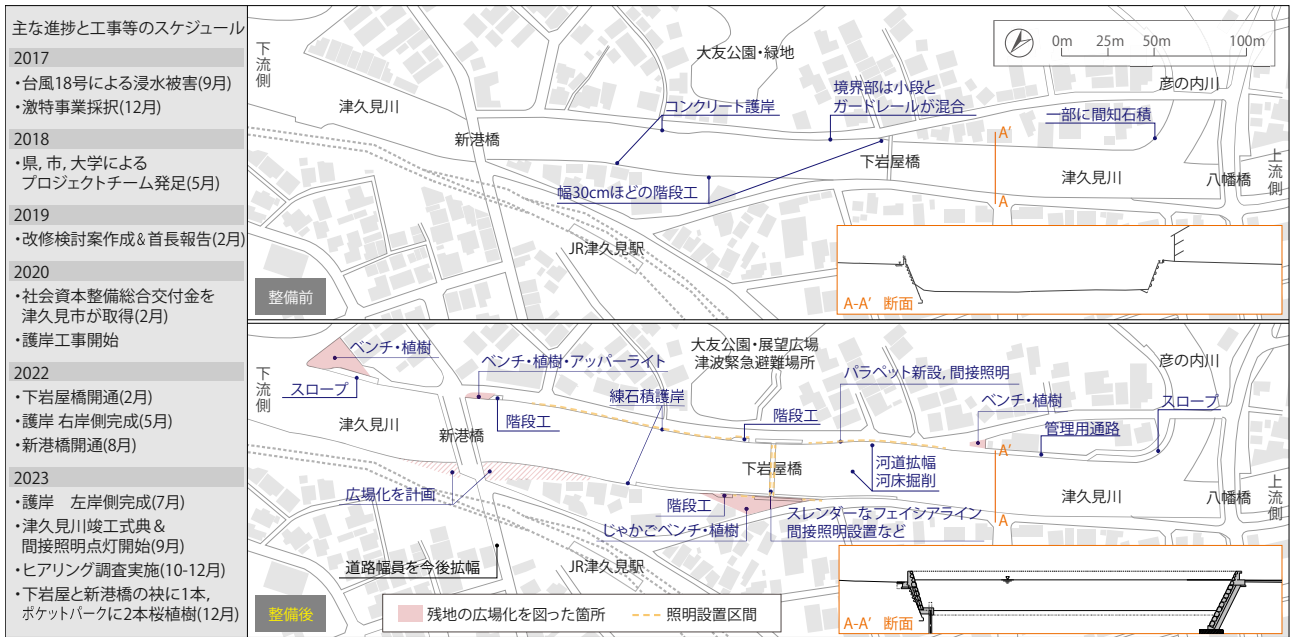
進捗およびスケジュールと整備前後の平面図（彦の内川合流部～新港橋下流側）
